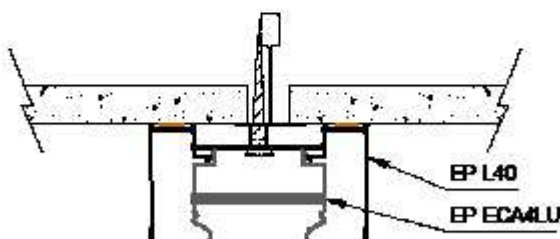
Fixation par clip d'une lisse haute sur un faux-plafond
